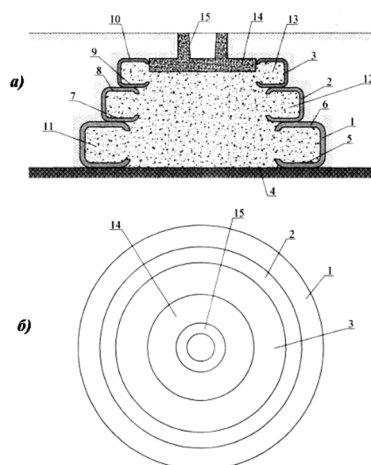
Фундамент мелкого заложения под колонны по патенту РФ №2704158:
